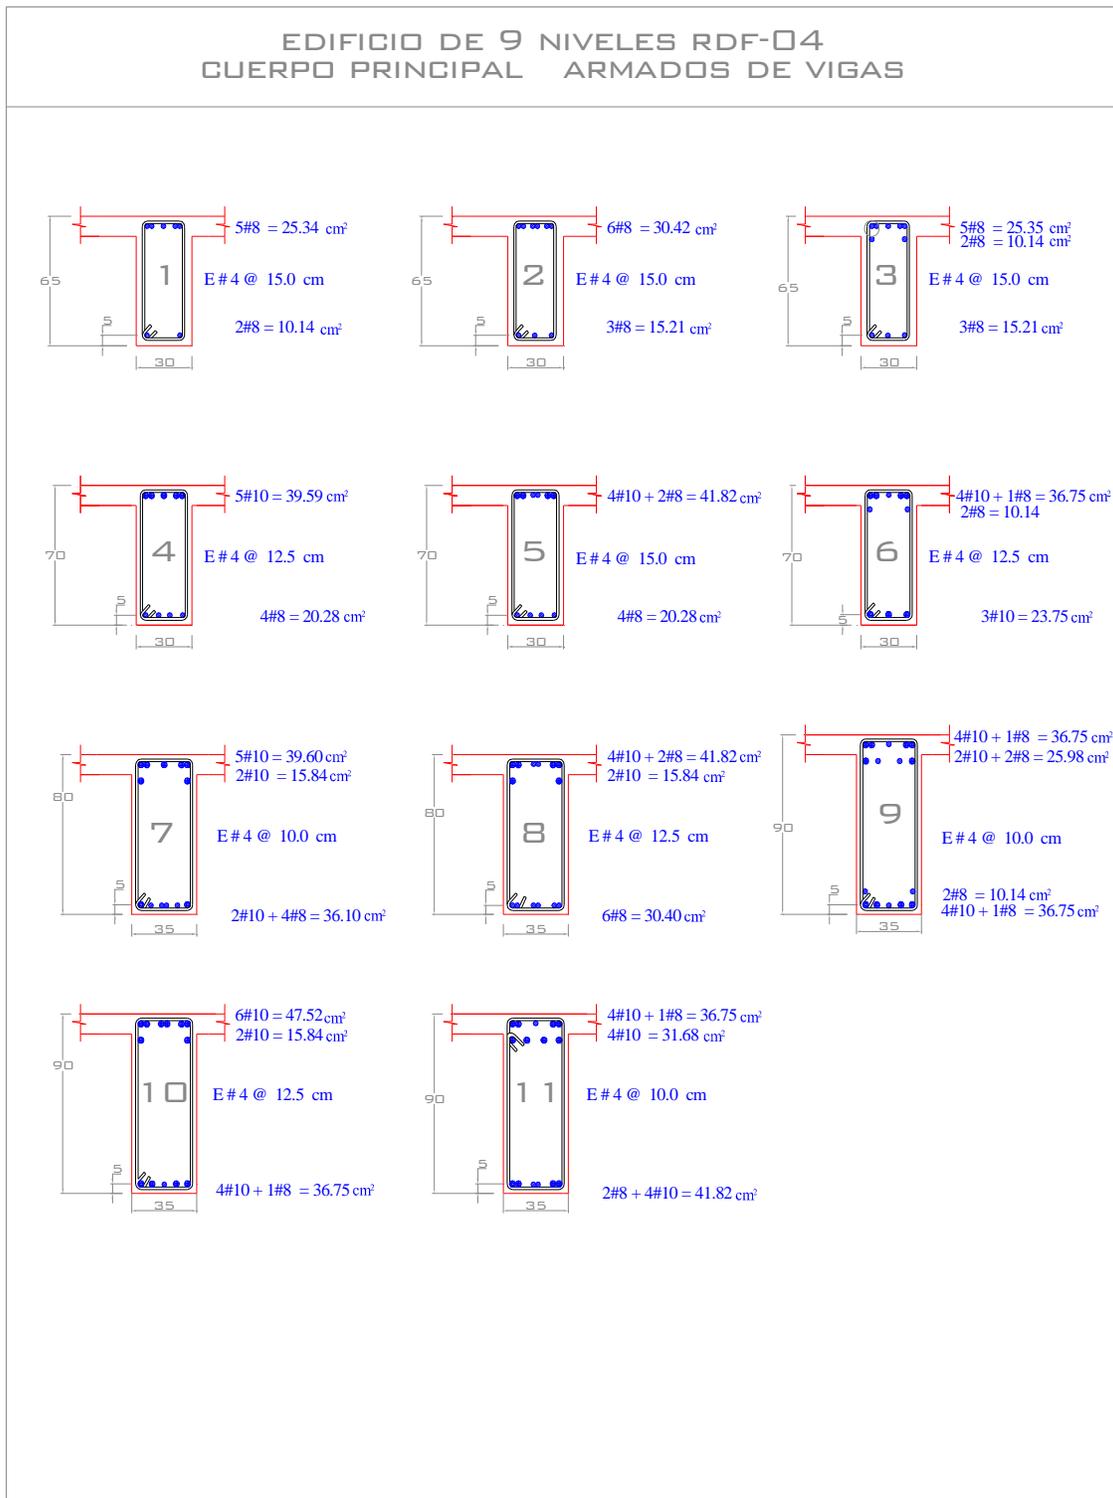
Armados longitudinal y transversal propuestos de las vigas del eje C, edificio 9 niveles, Cuerpo Principal (caso A) de las NTC-Sismo, RDF-04
